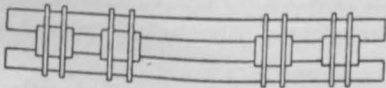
Parallelträger mit eingelassenen Querstücken.
